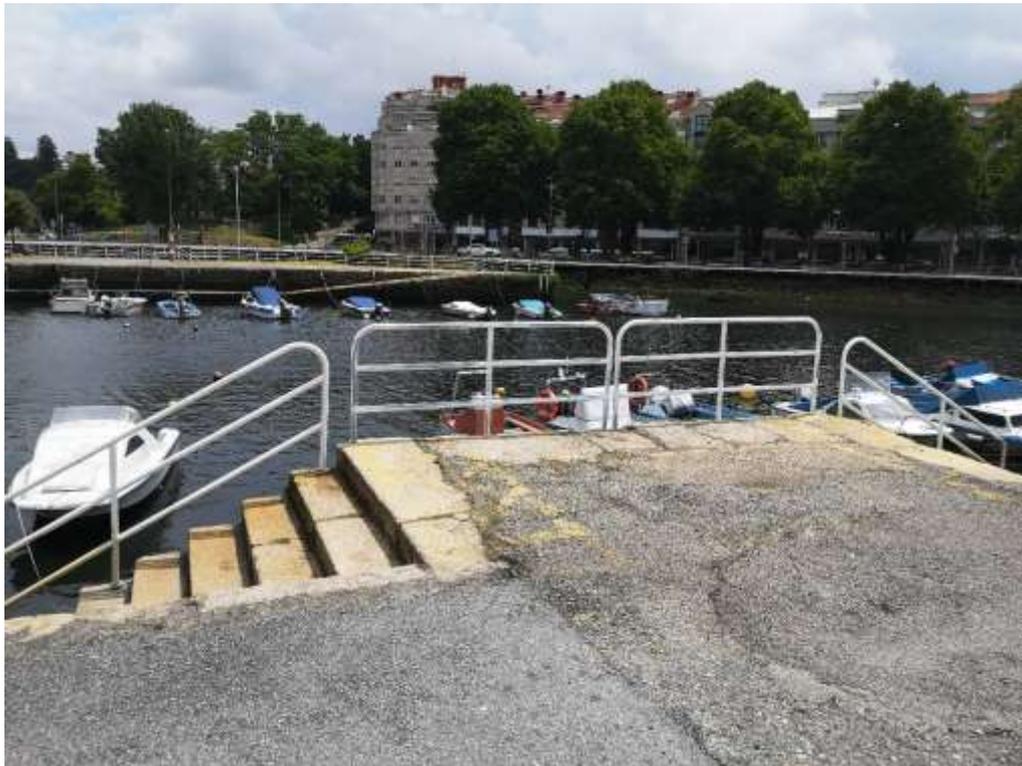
Escaleras de acceso a la zona de amarre de las embarcaciones. Fuente: ACADAR
